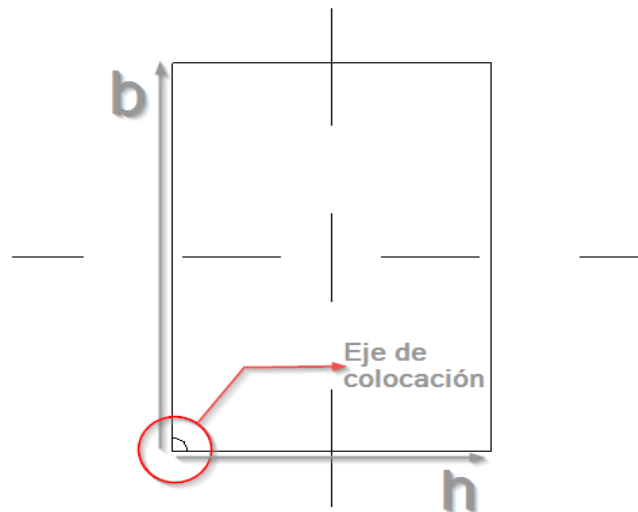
Detalle pilar en planta. Fuente: Creación propia, Revit (2018)
